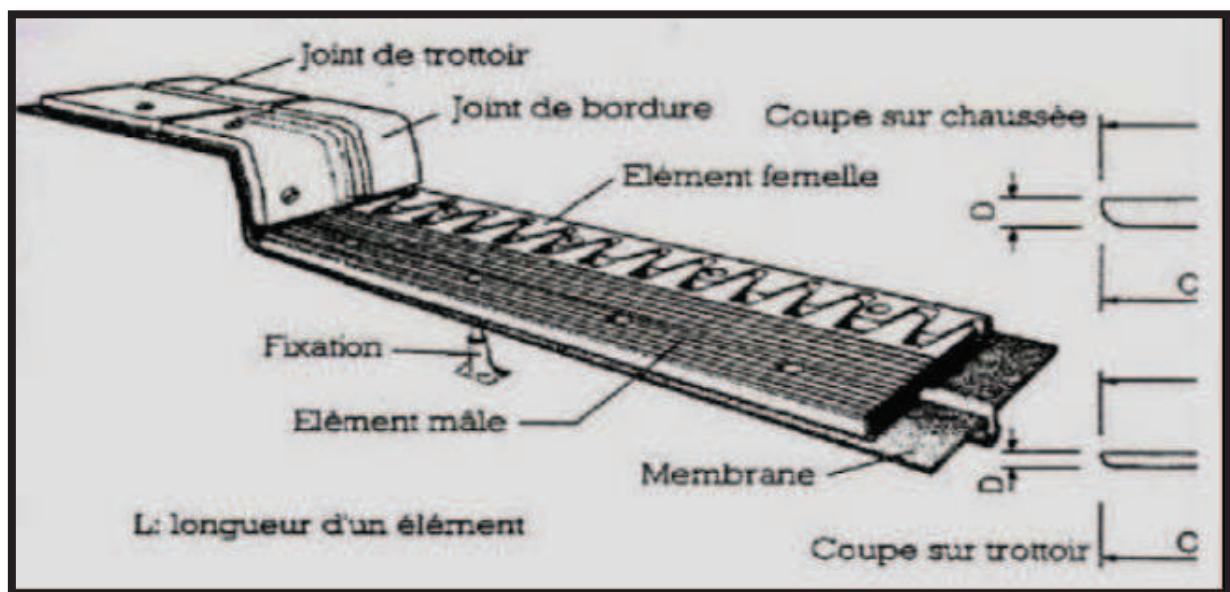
Les différents éléments d'un joint de chaussée.
